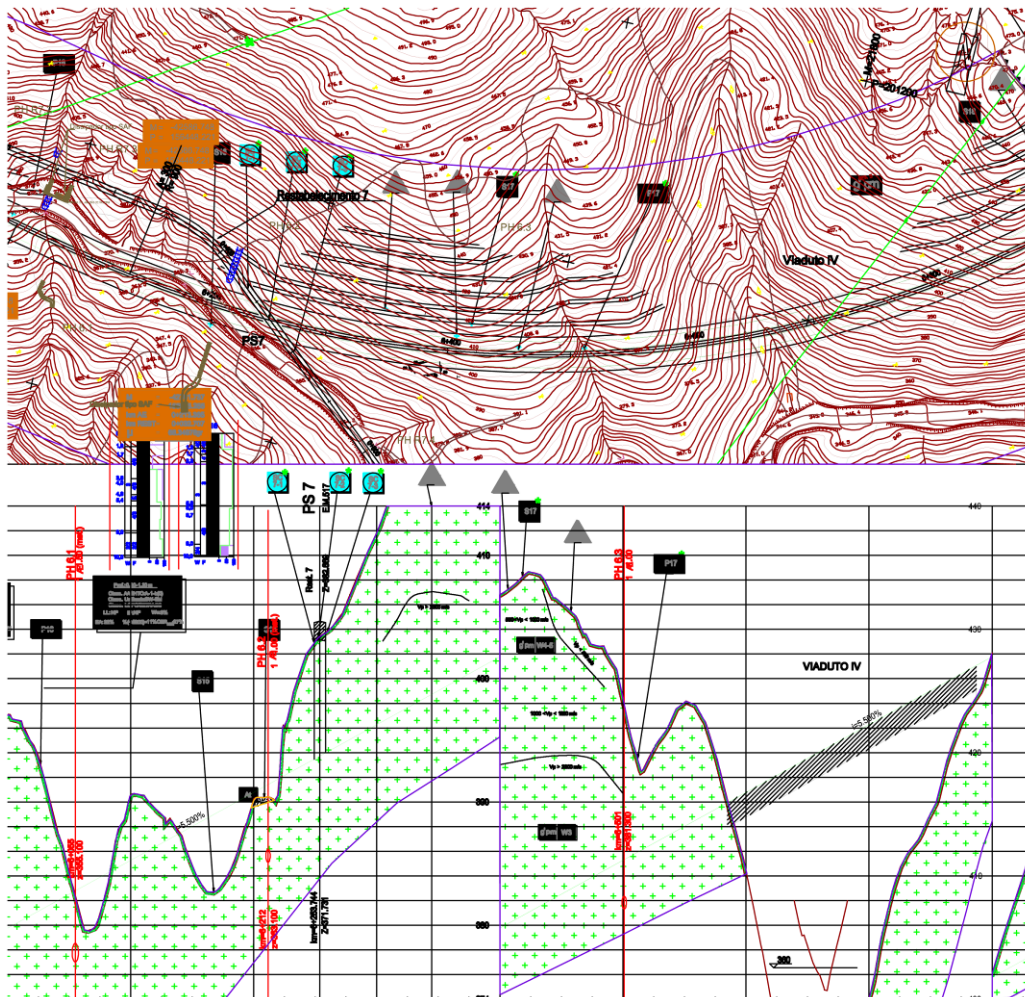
Planta de localização: condições topográficas e perfil geotécnico da obra (Batista et al., 2002).
